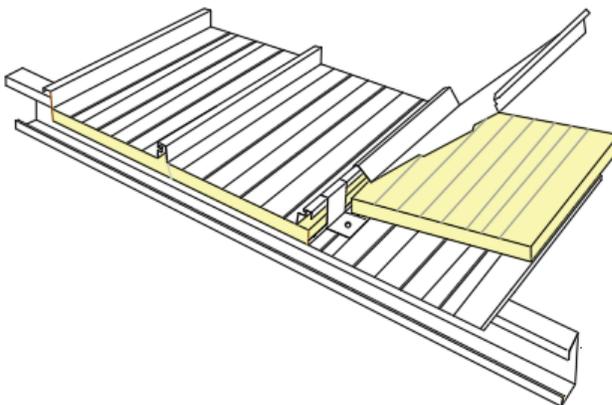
Forma de instalación cubierta Sistema Sándwich Deck Tipo C.
